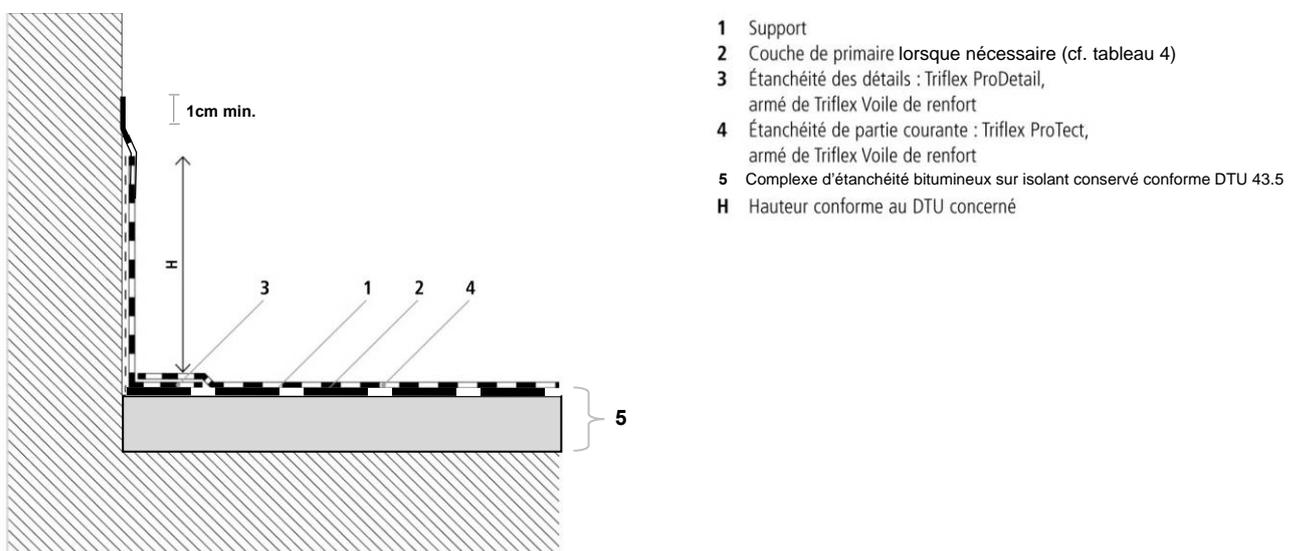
Relevé des toitures-terrasses sur complexe d'étanchéité bitumineux conservé - solution Triflex ProTect
